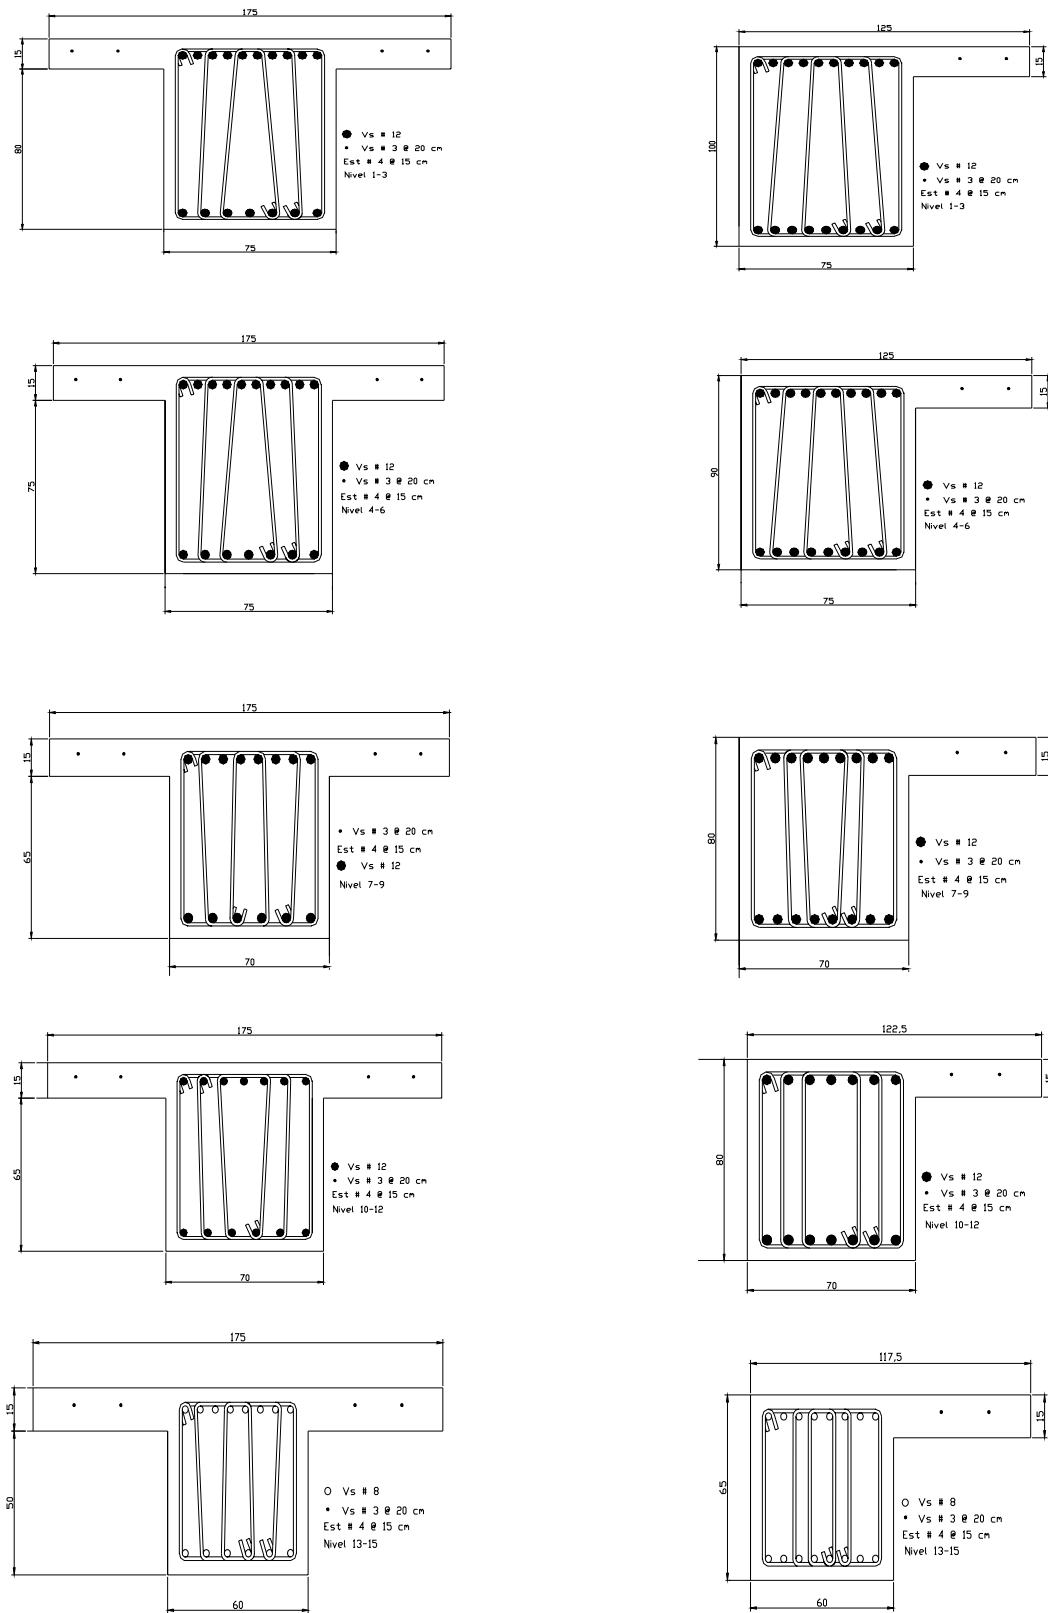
Detallado de Vigas de Marcos Interior y Exterior respectivamente, Dirección X para el Edificio A.
